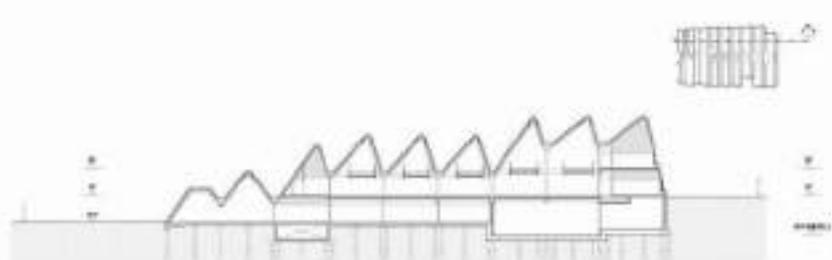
Fachada - Design Strategy & Research Center. Plano de The System Lab (Plataforma Arquitectura, 2017)
